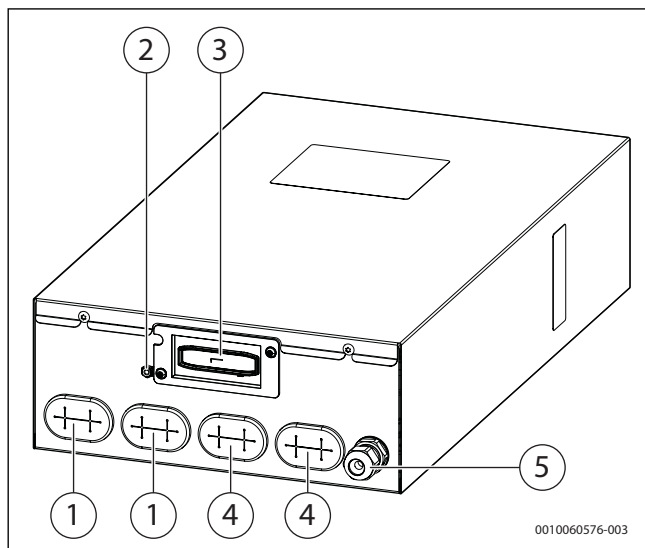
Kabelverschraubungen und -durchführungen am Wärmepumpenregler
